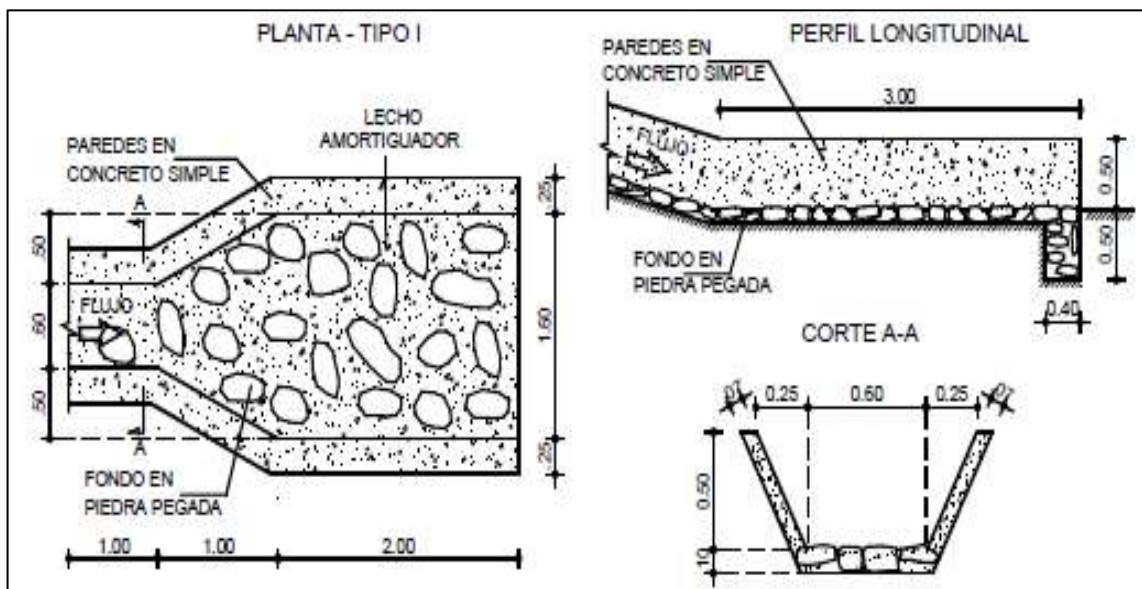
Protección de entrega de un canal en piedra pegada con mortero (Suárez Díaz, 2001).
